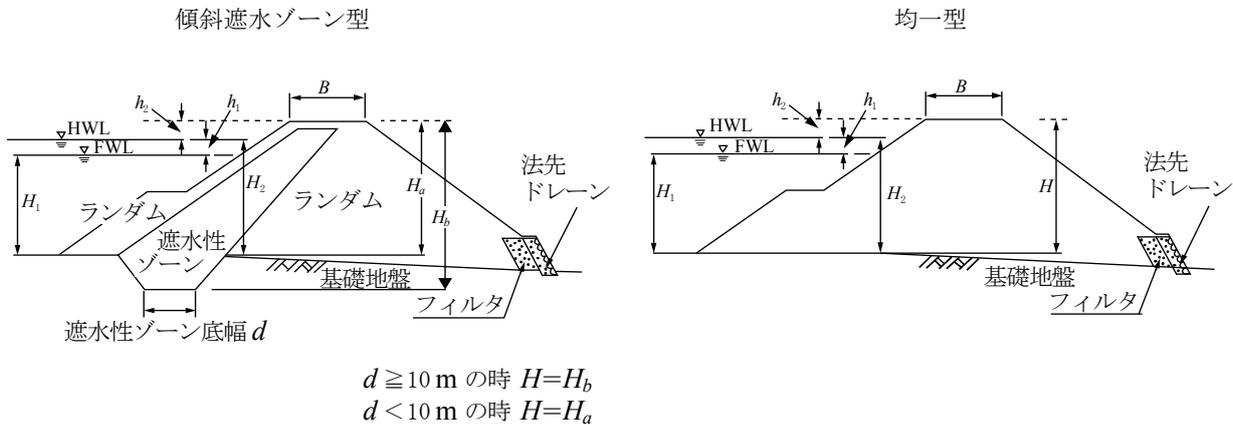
傾斜遮水性ゾーン型及び均一型の堤体断面
